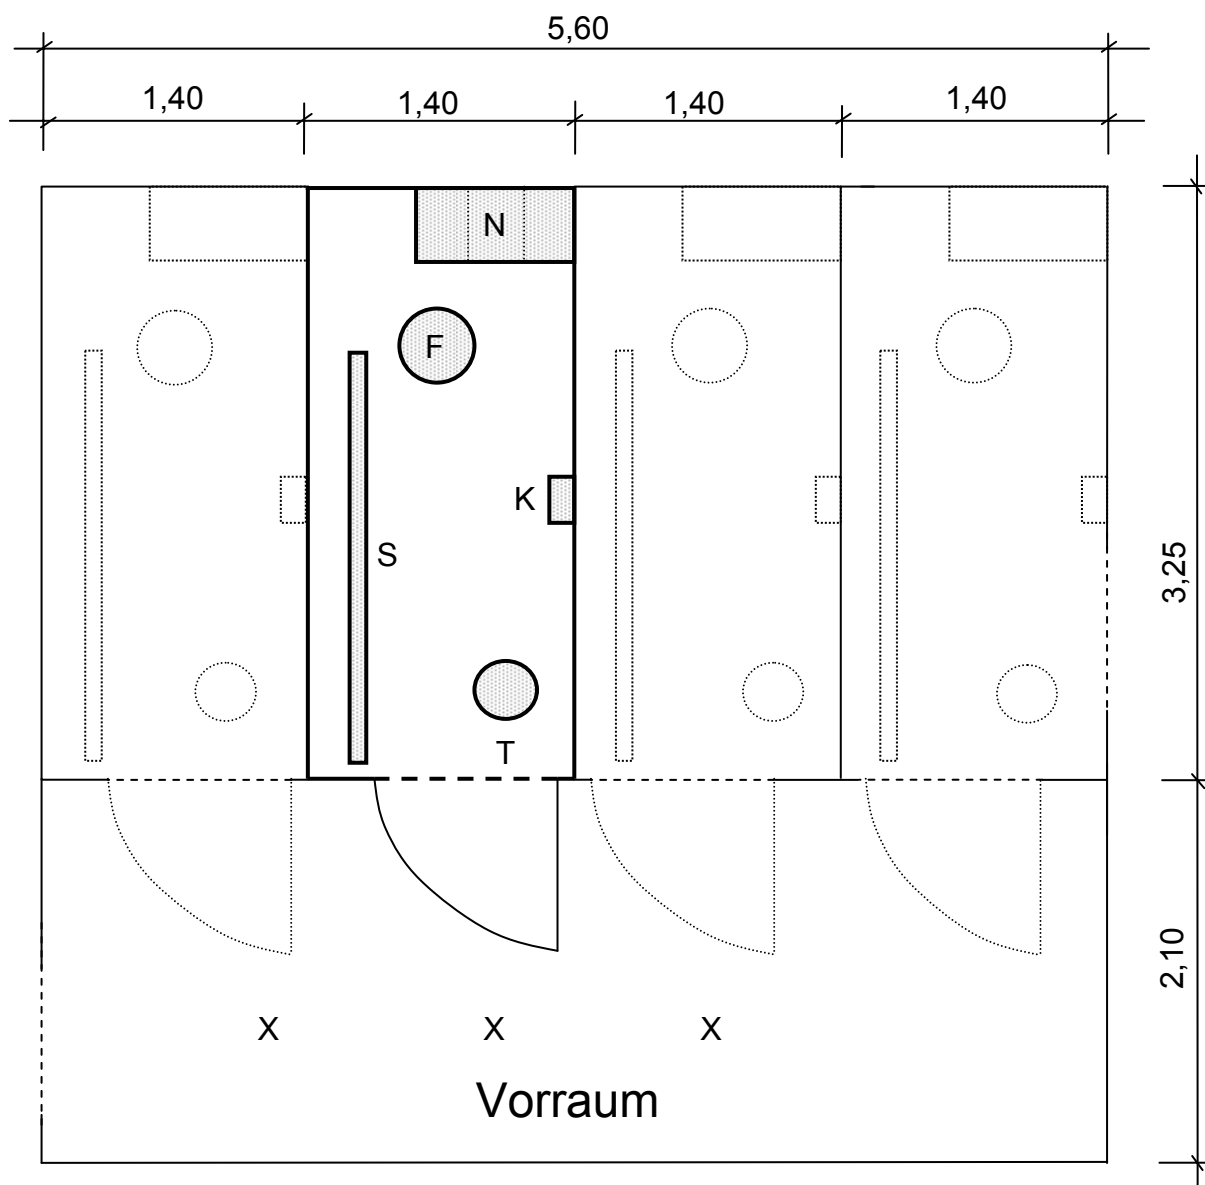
Grundriss des Stalles mit vier Abteilen
